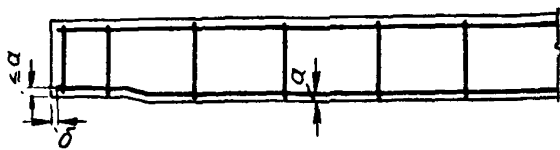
Армирование концов сборных железобетонных элементов с подрезкой на опорах
